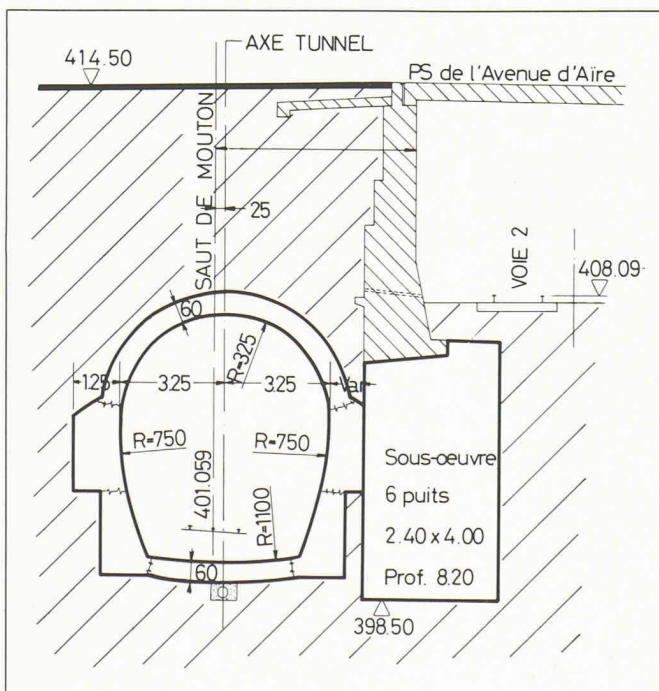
Lot C, secteur 5: coupe type au droit du passage supérieur.
